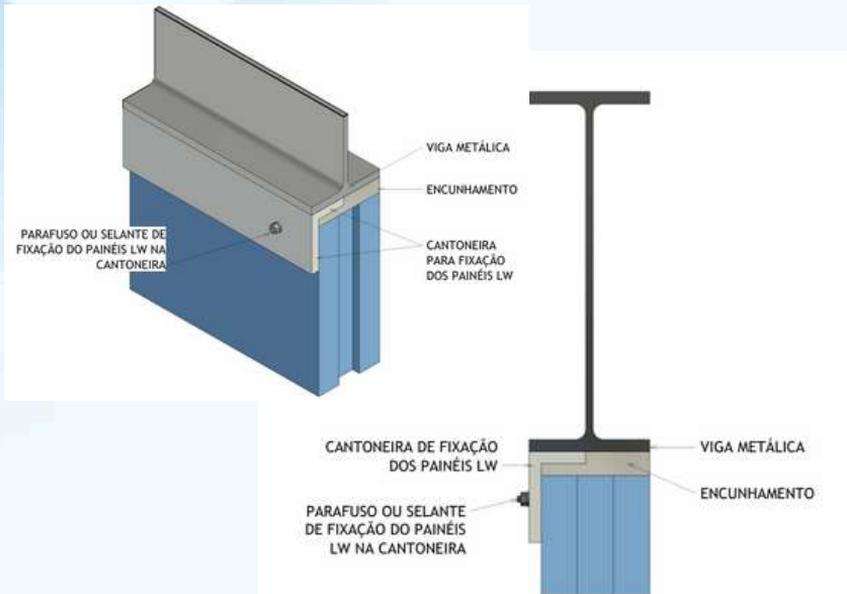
utilização de cantoneira metálica junto a viga I com o objetivo de auxiliar o travamento do painel Lightwall
